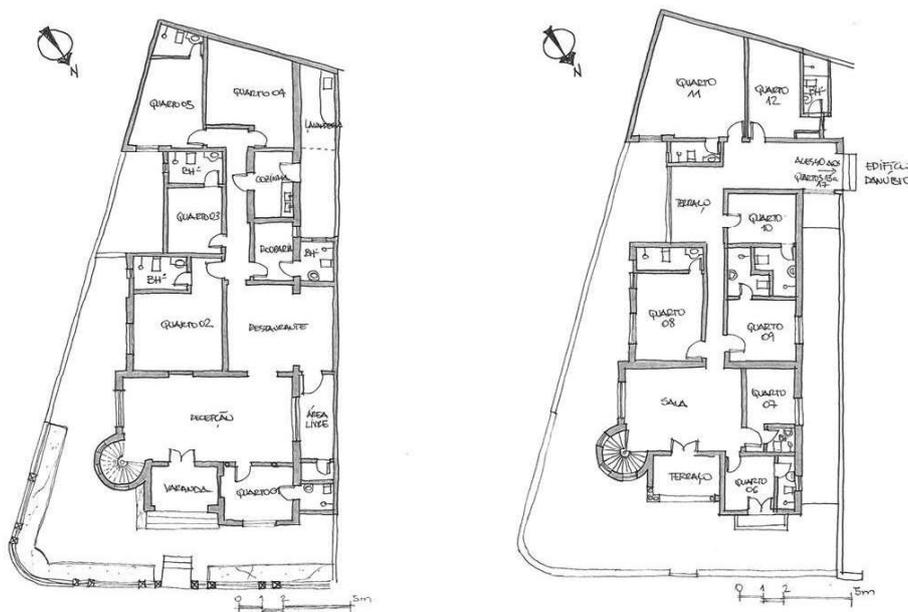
Planta Baixa pavimento Térreo e Superior da Residência N°220.
